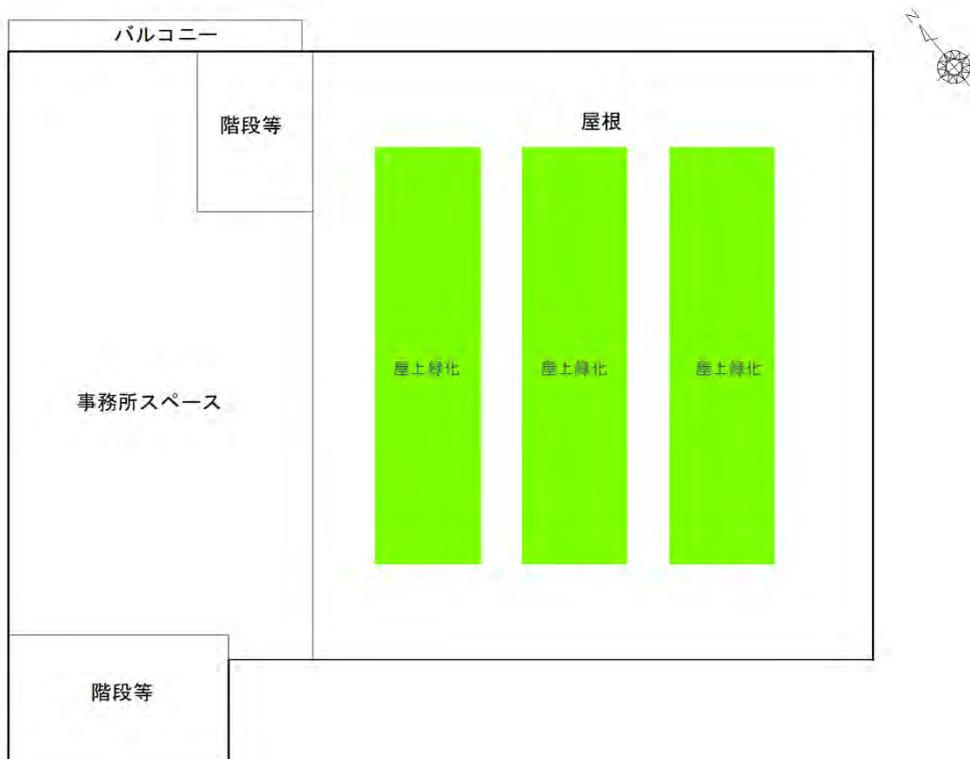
(8) 廃棄物受入棟平面図 (7階)
